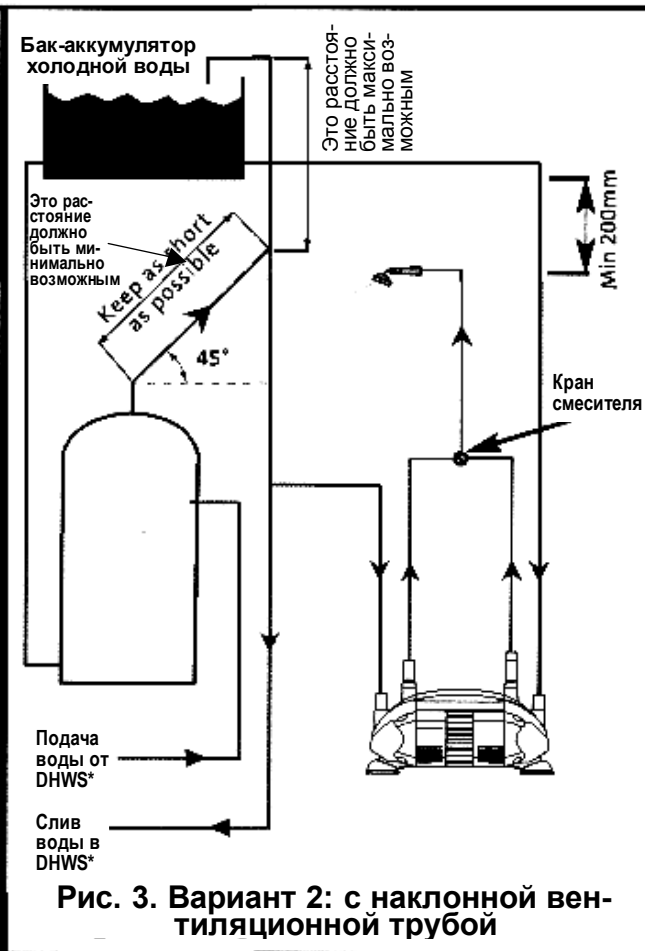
Вариант 2: с наклонной вентиляционной трубой
